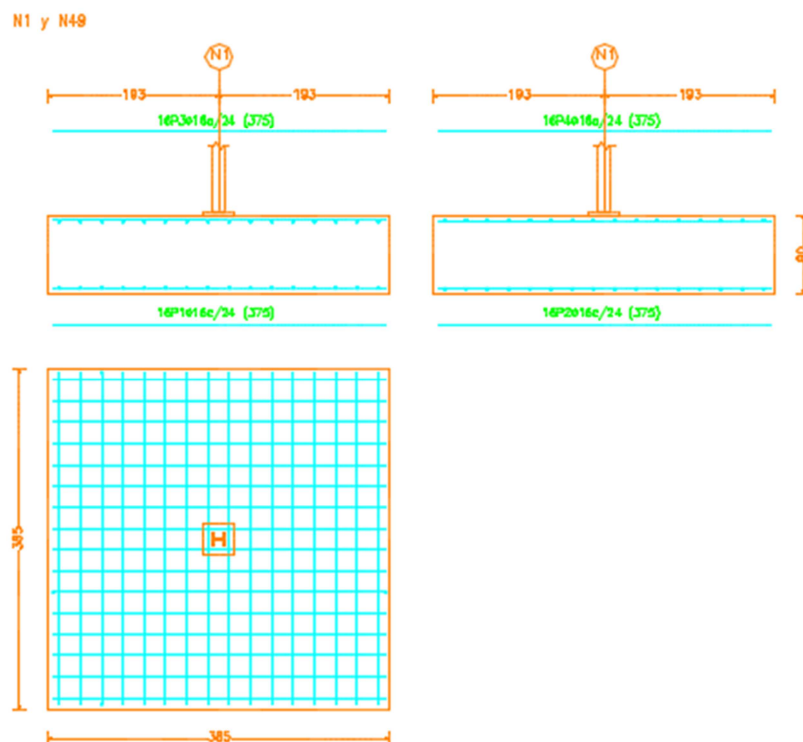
Detalle de la cimentación de los pilares extremos de pórticos de fachada
